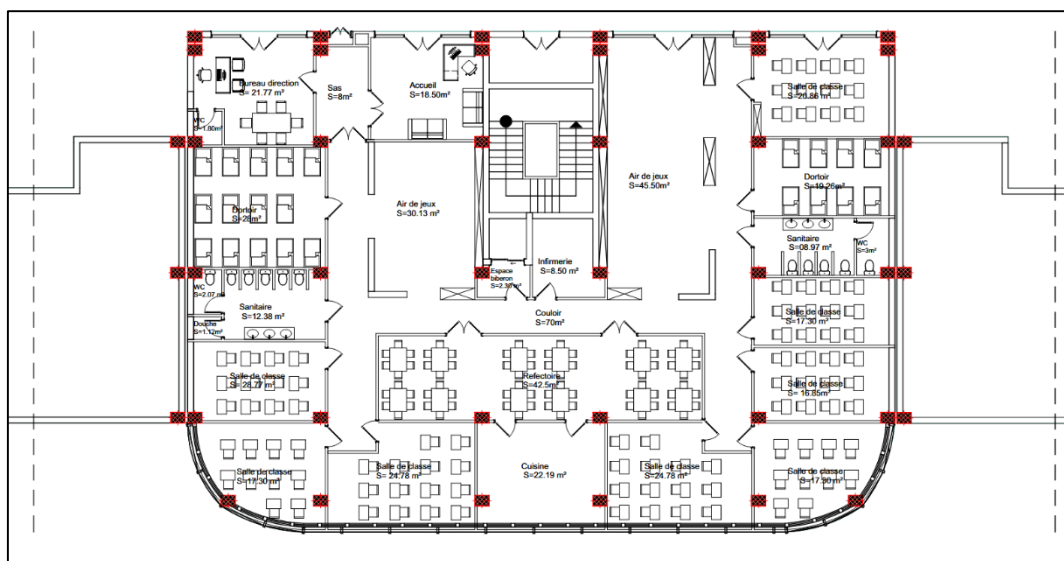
Plan de la crèche mes belles journées.(Source: Auteur,2025)
